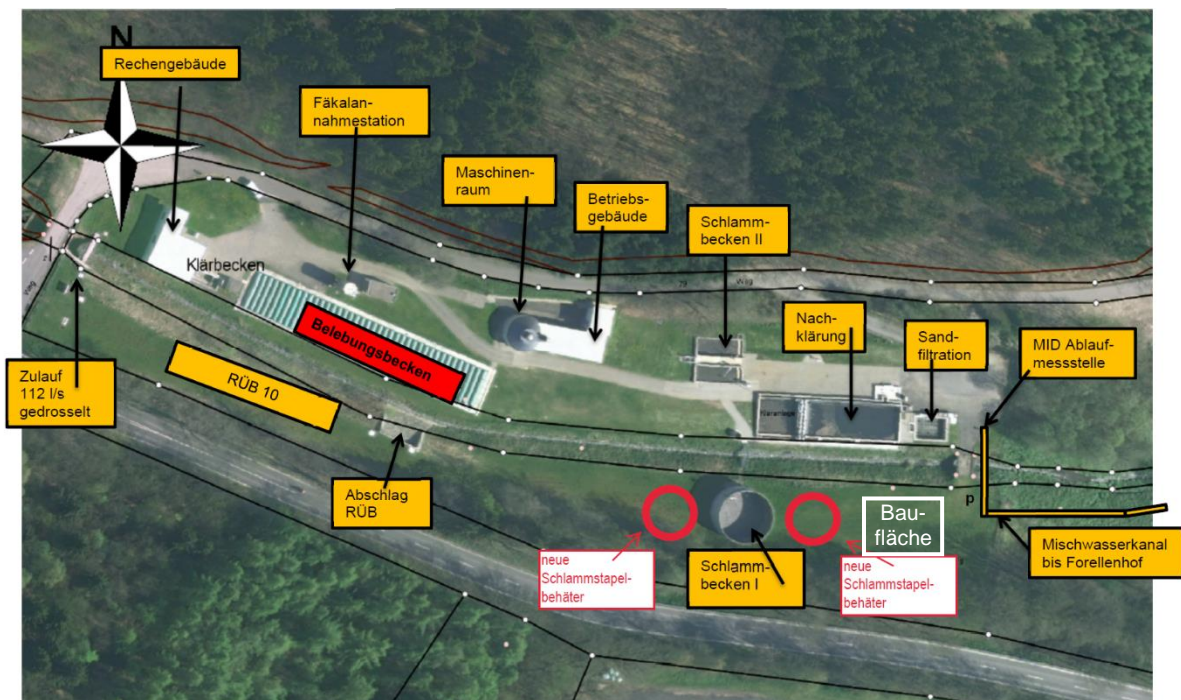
Lageplanschema (potenzielle Baufläche für 4. Reinigungsstufe: weiße Markierung)
